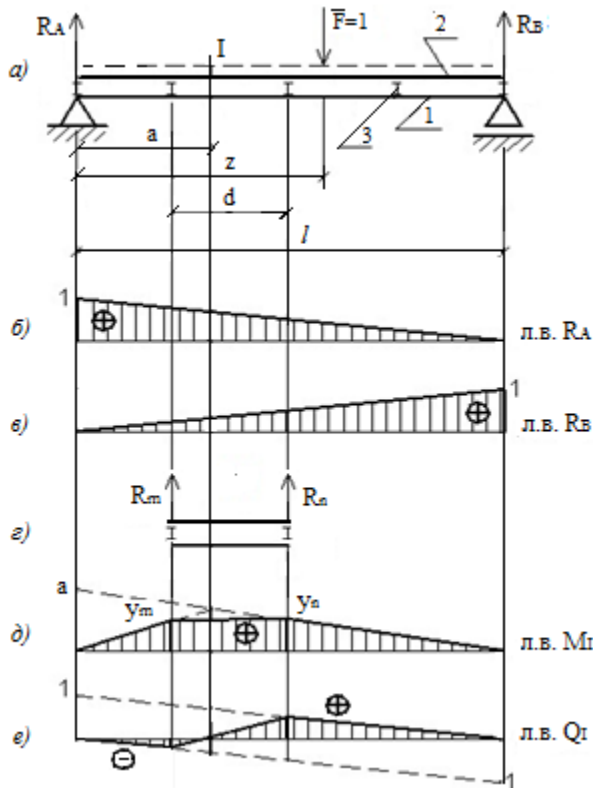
Расчетная схема балки при узловой передаче нагрузки
